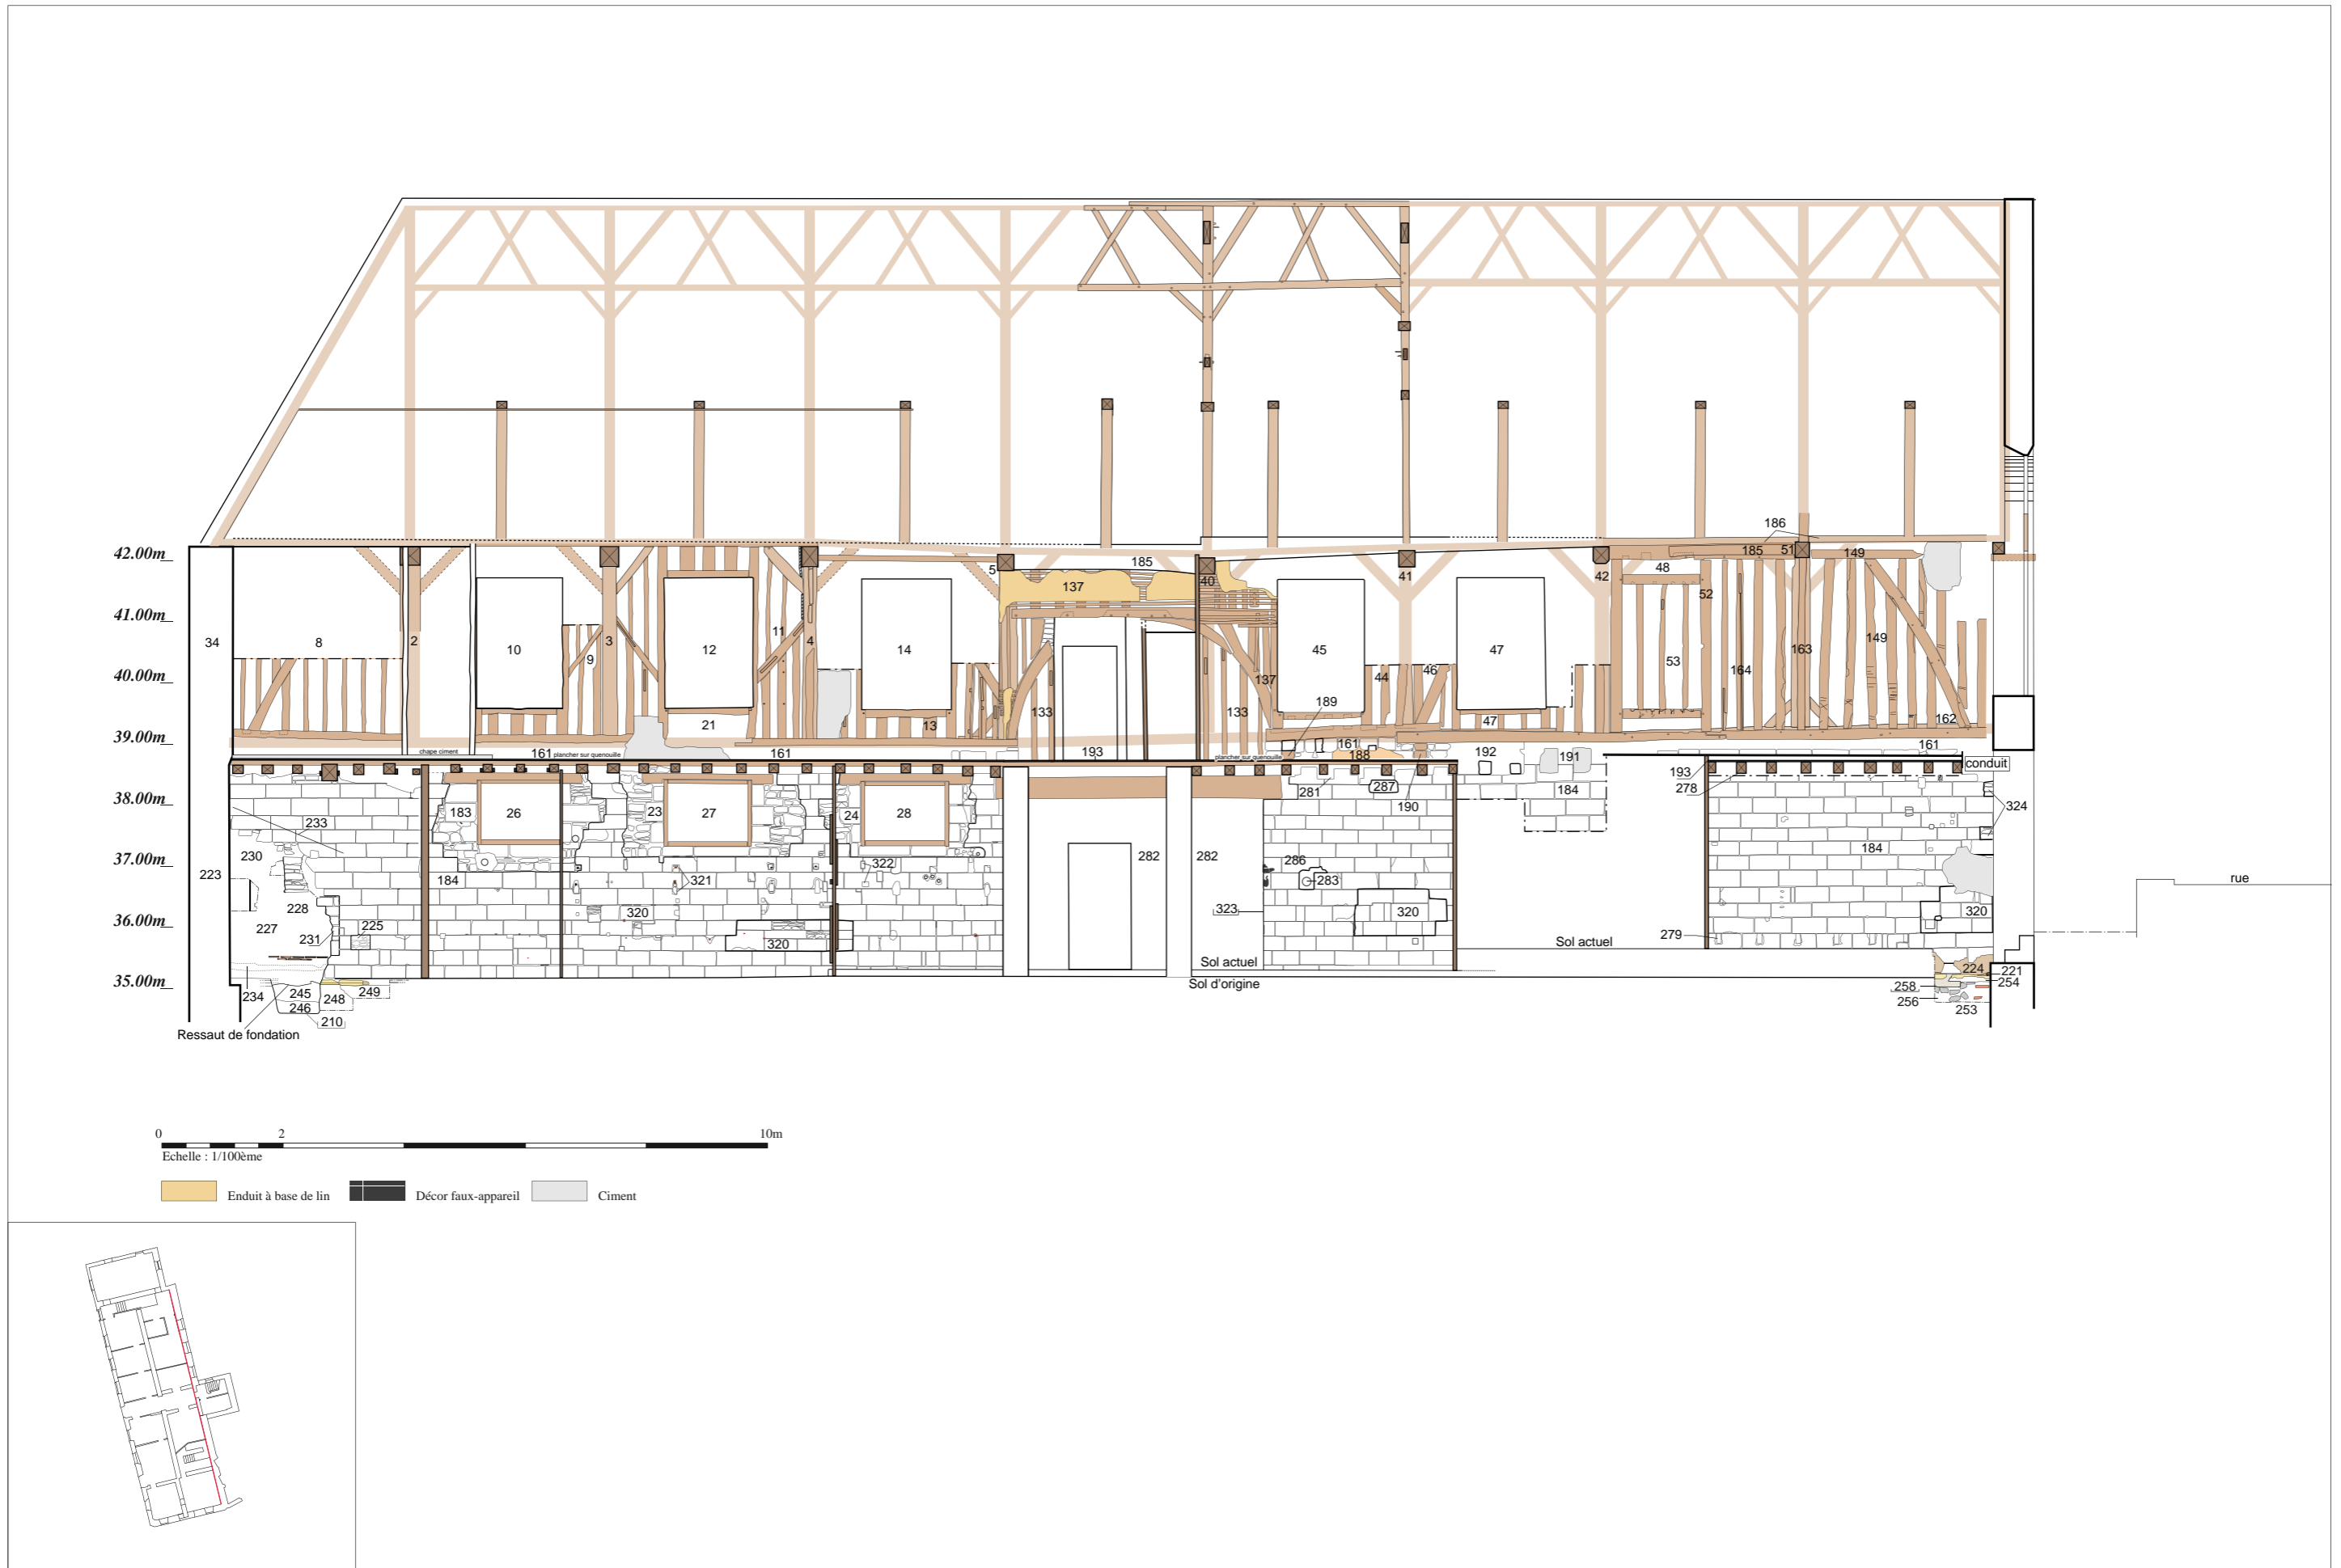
La coupe longitudinale © Arnaud Desfonds, Elen Esnault, Inrap
